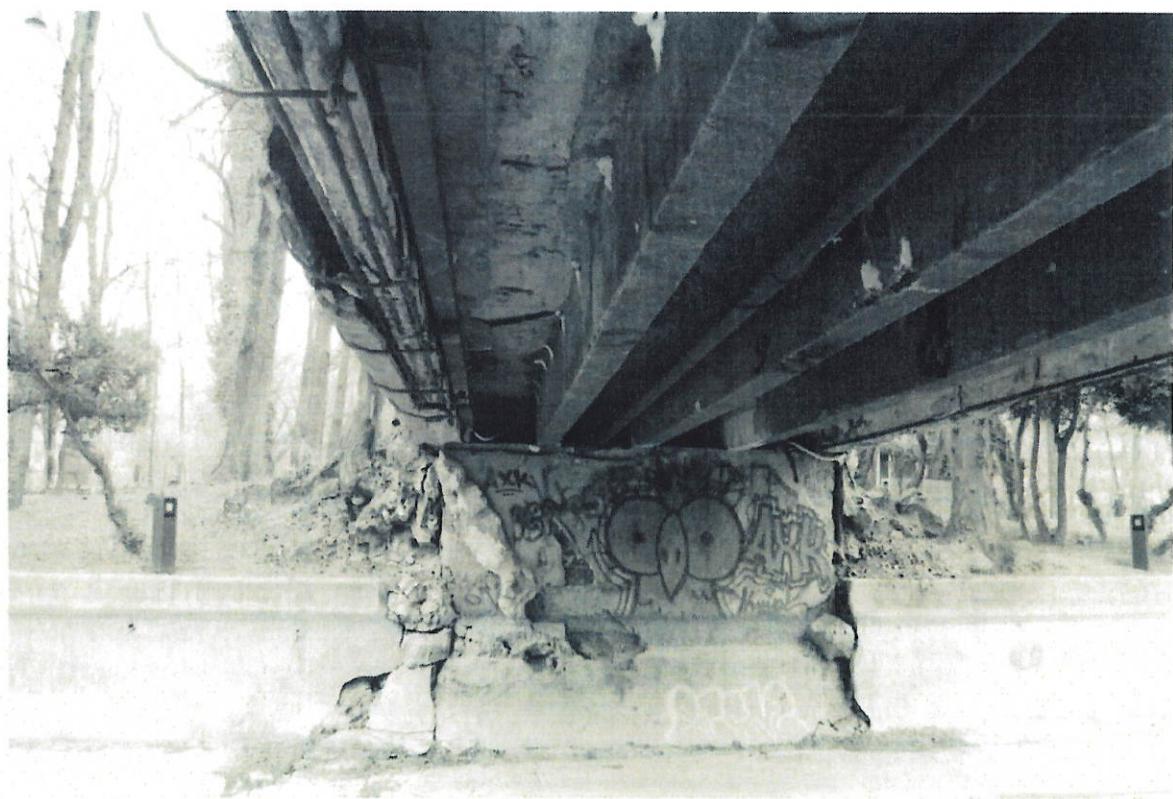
Vedere intrados pod pietonal – betoane degradate, armatura vizibila
